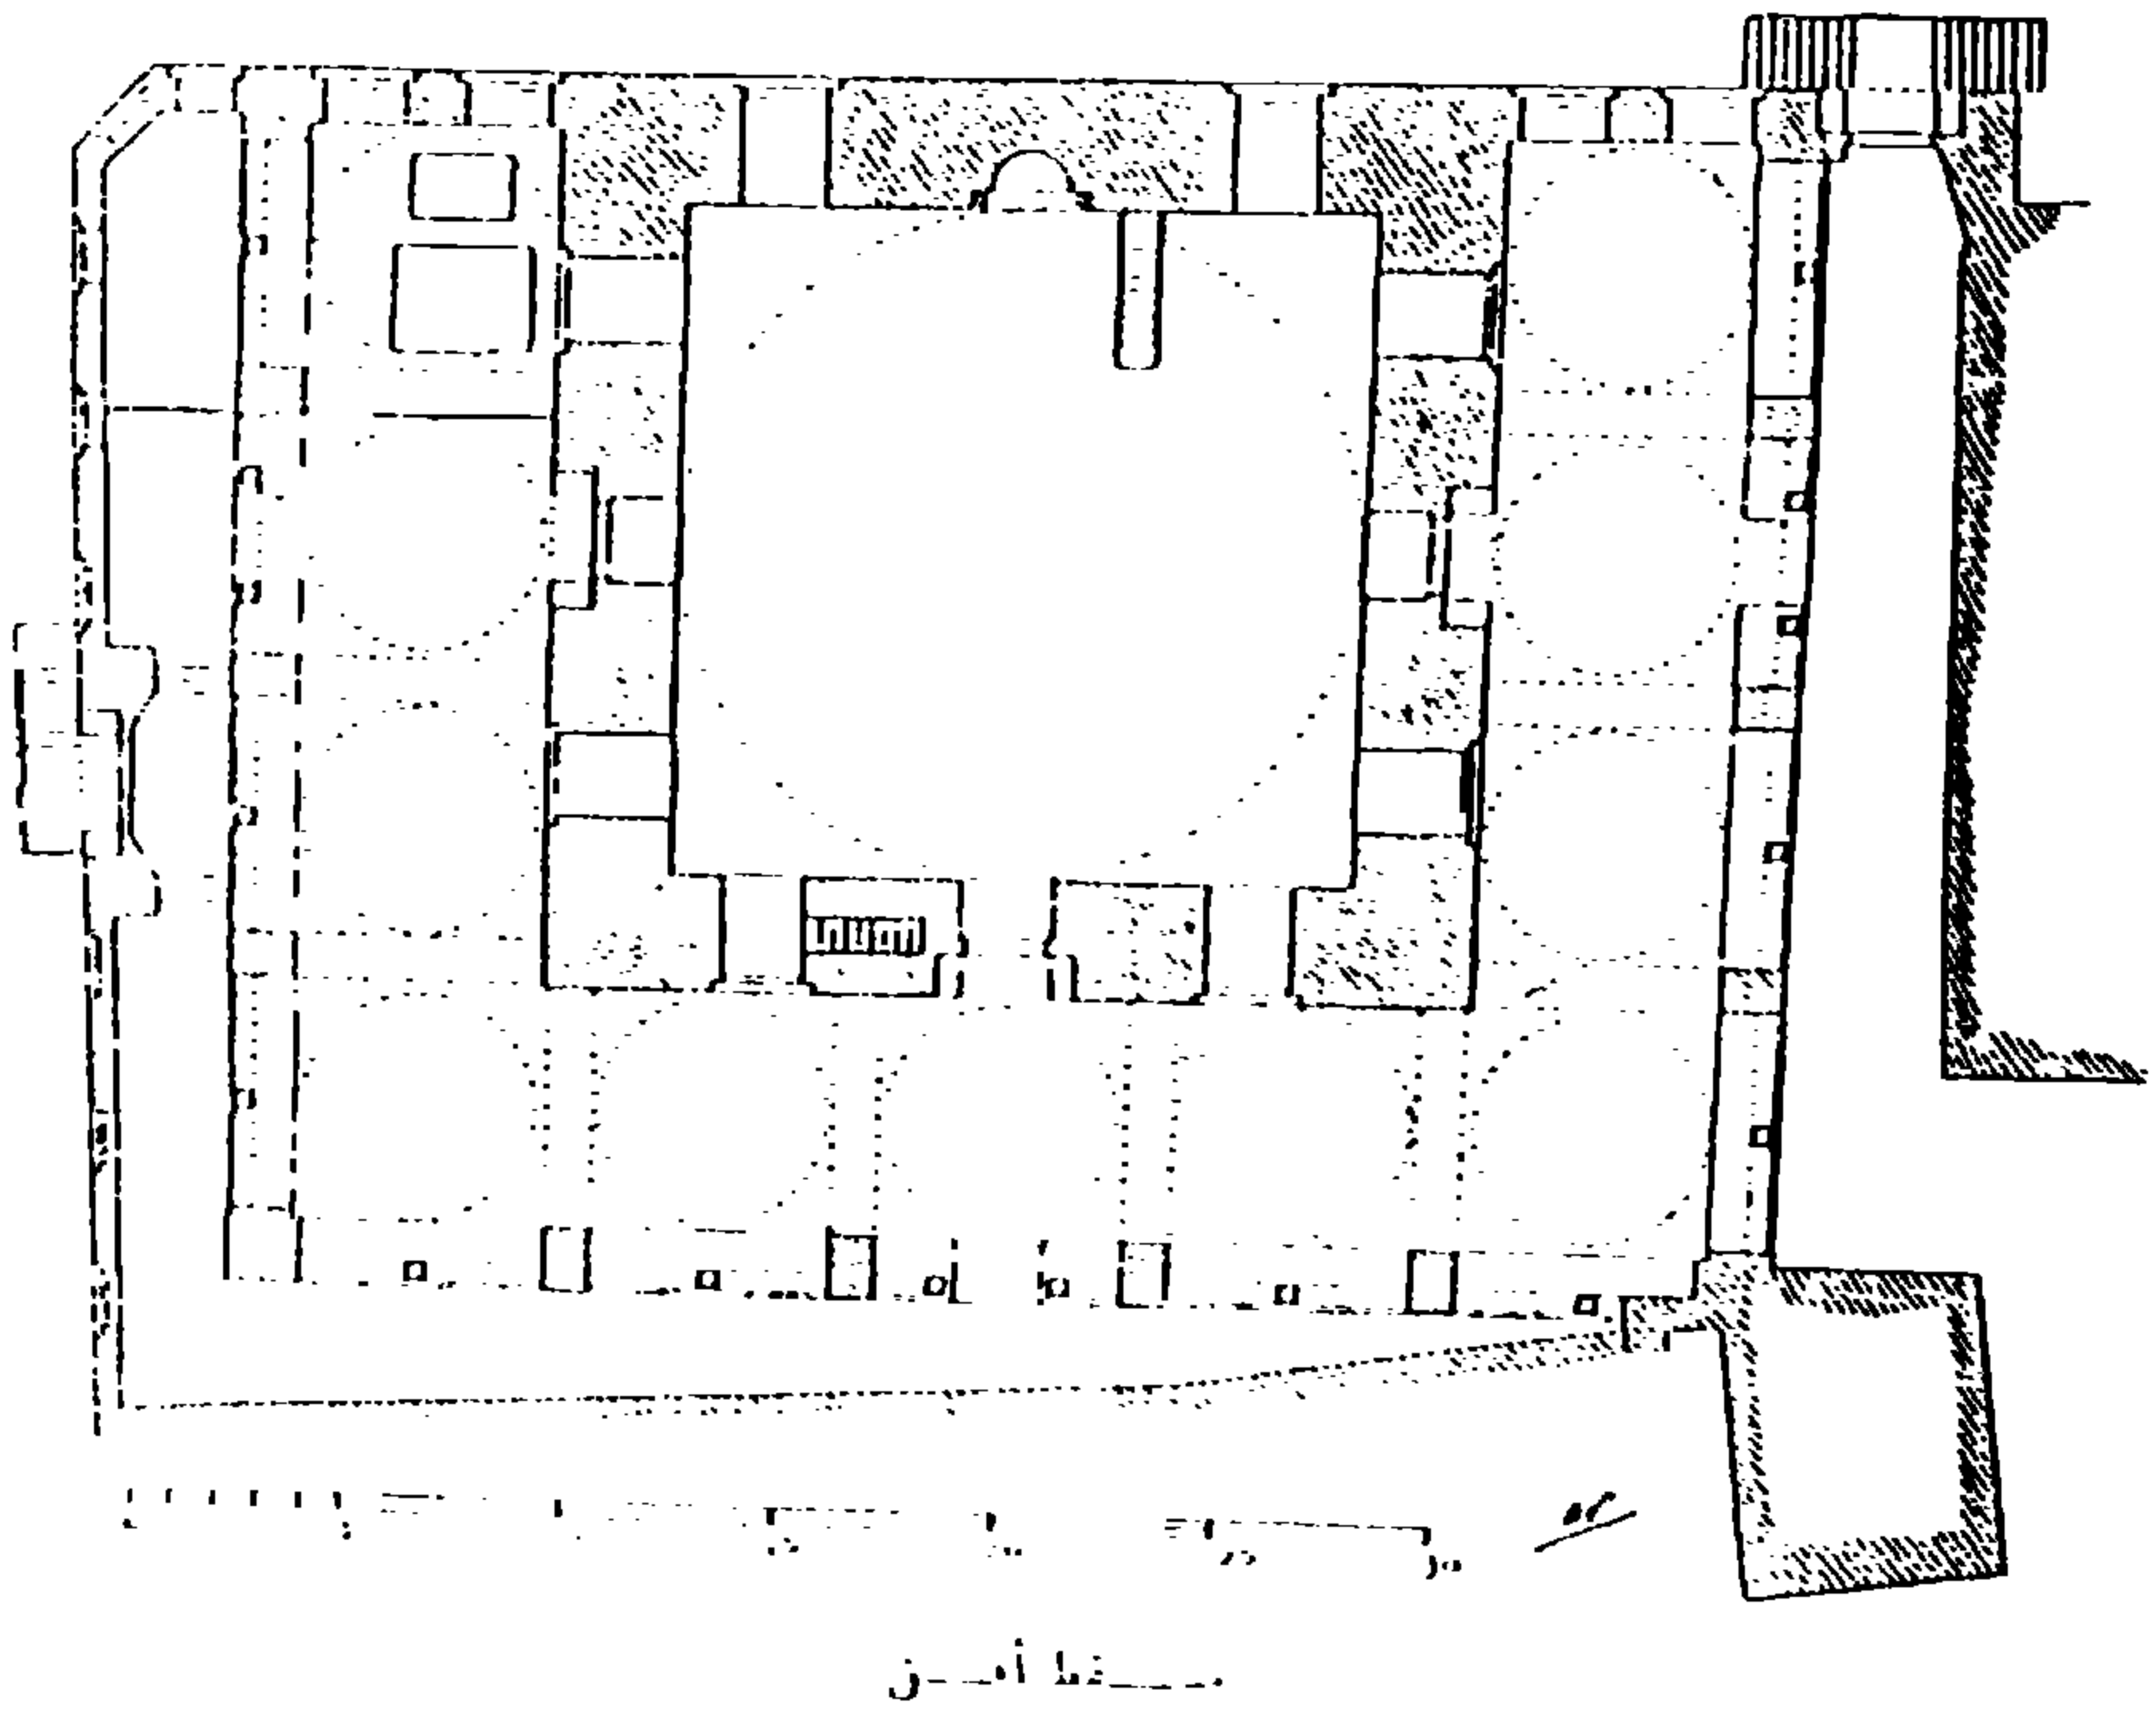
المسقط الأفقى لجامع أحمد كتخدا العزب
